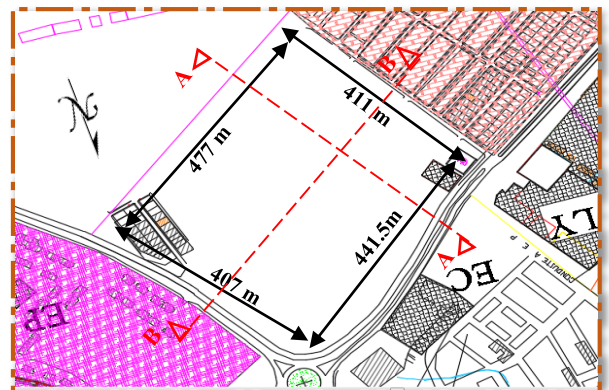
Plan de masse de site Source: PDAU Djelfa
